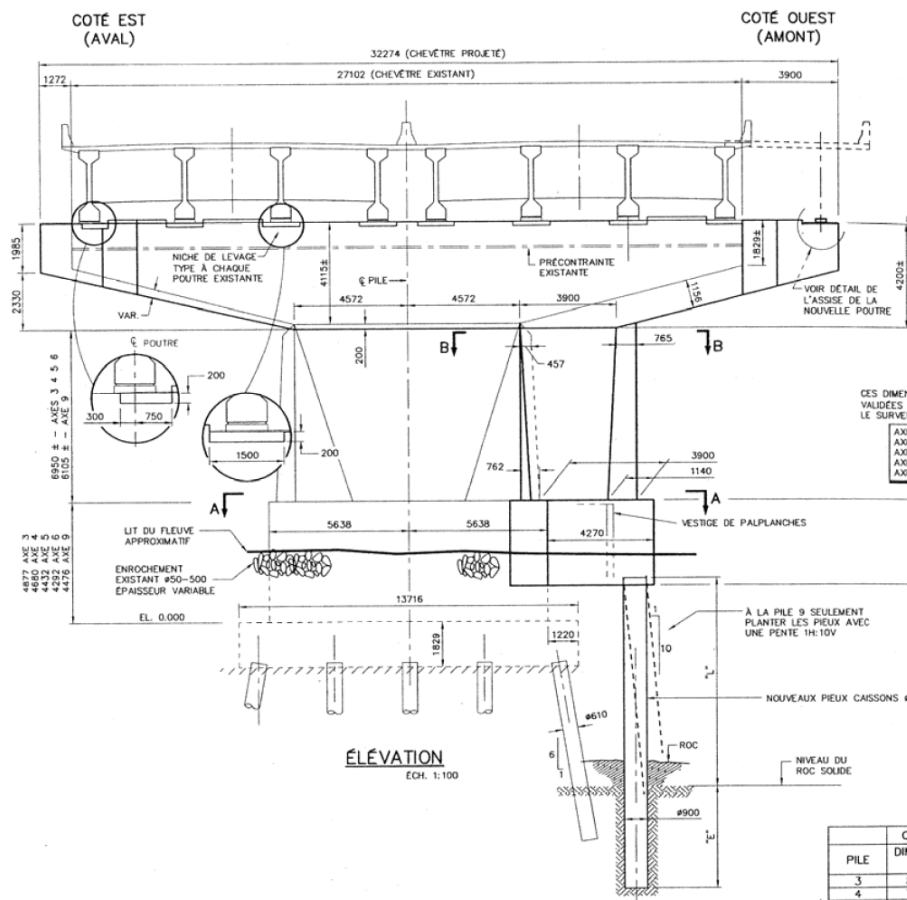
vista da travessa e alargamentos com inserção de nova estaca e alargamento do bloco
